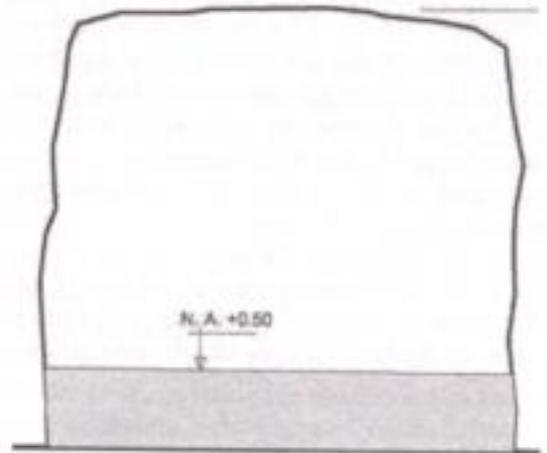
Corte de la galería de arco rebajado tipo mina en la Galería Filtrante Zapata
